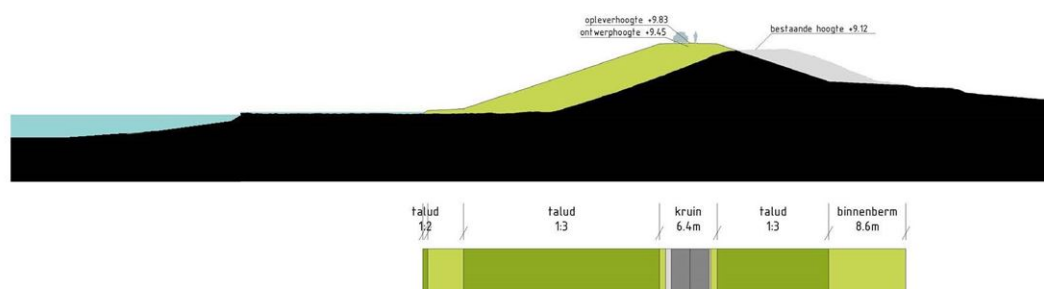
Verschil in ontwerp tussen VKA en planuitwerking voor binnendijkse versterking
